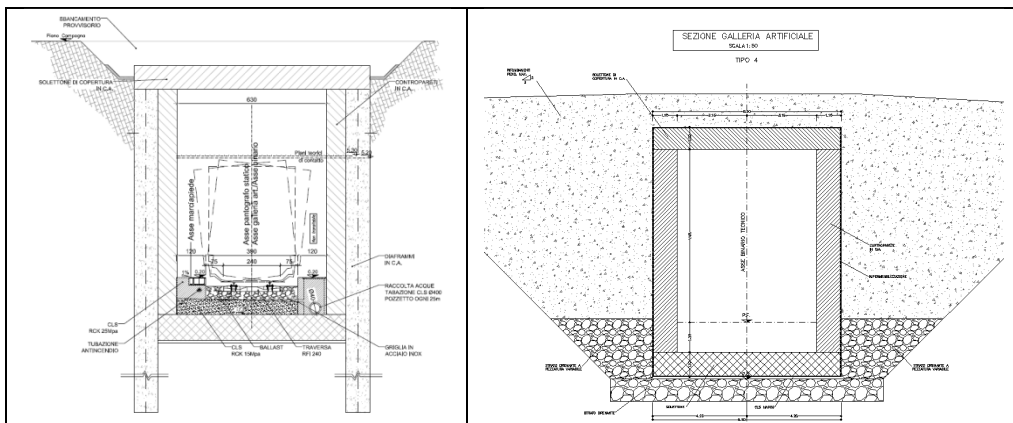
Galleria artificiale (sezione tipo “2”) e “Drenante” (sezione tipo “4”)
